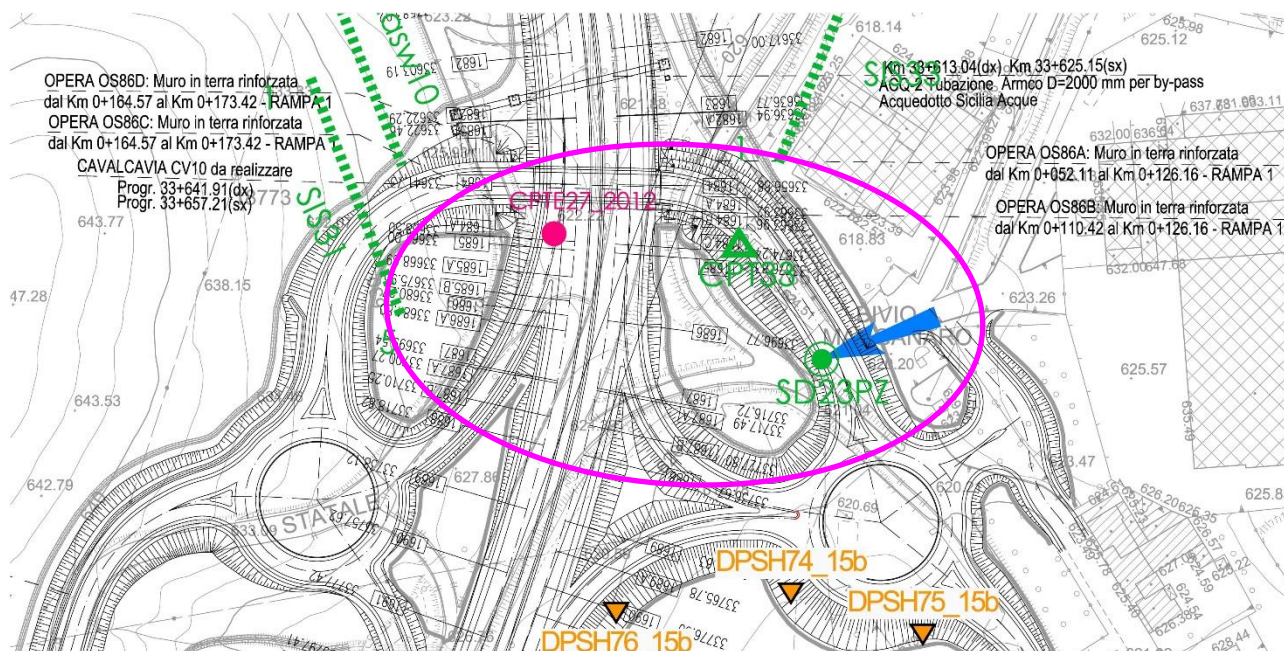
Planimetria con ubicazione indagini geotecniche disponibili.
